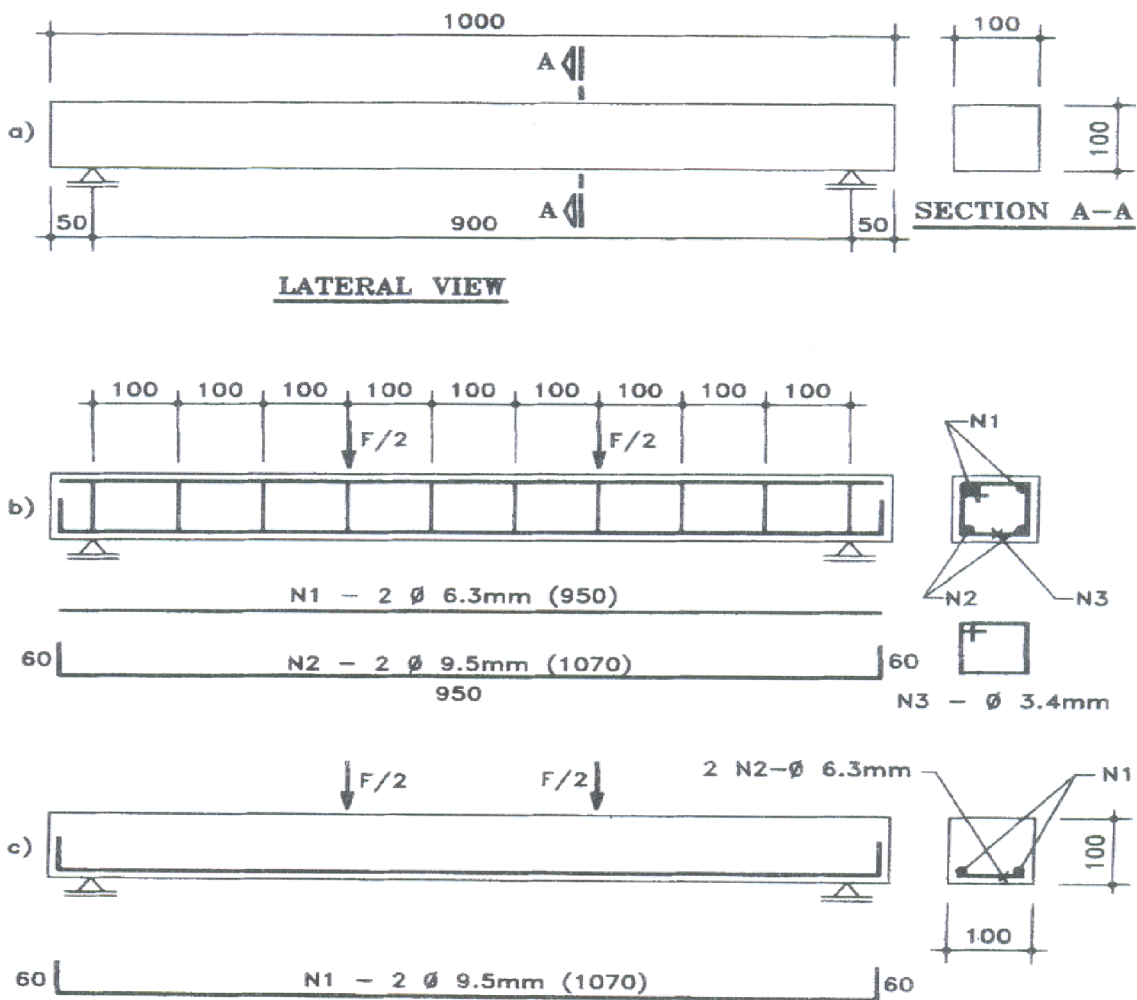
(a) Géométrie, (b) Renforcement des poutres série A, (c) Renforcement des poutres série B [14].
